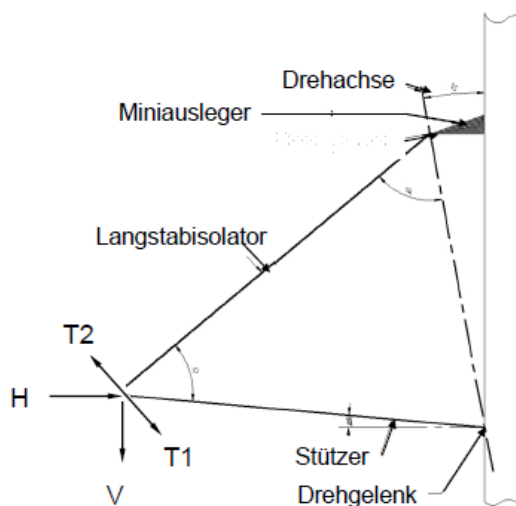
Prinzipieller Aufbau einer Isoliertraverse „gelenkiges“ Design
